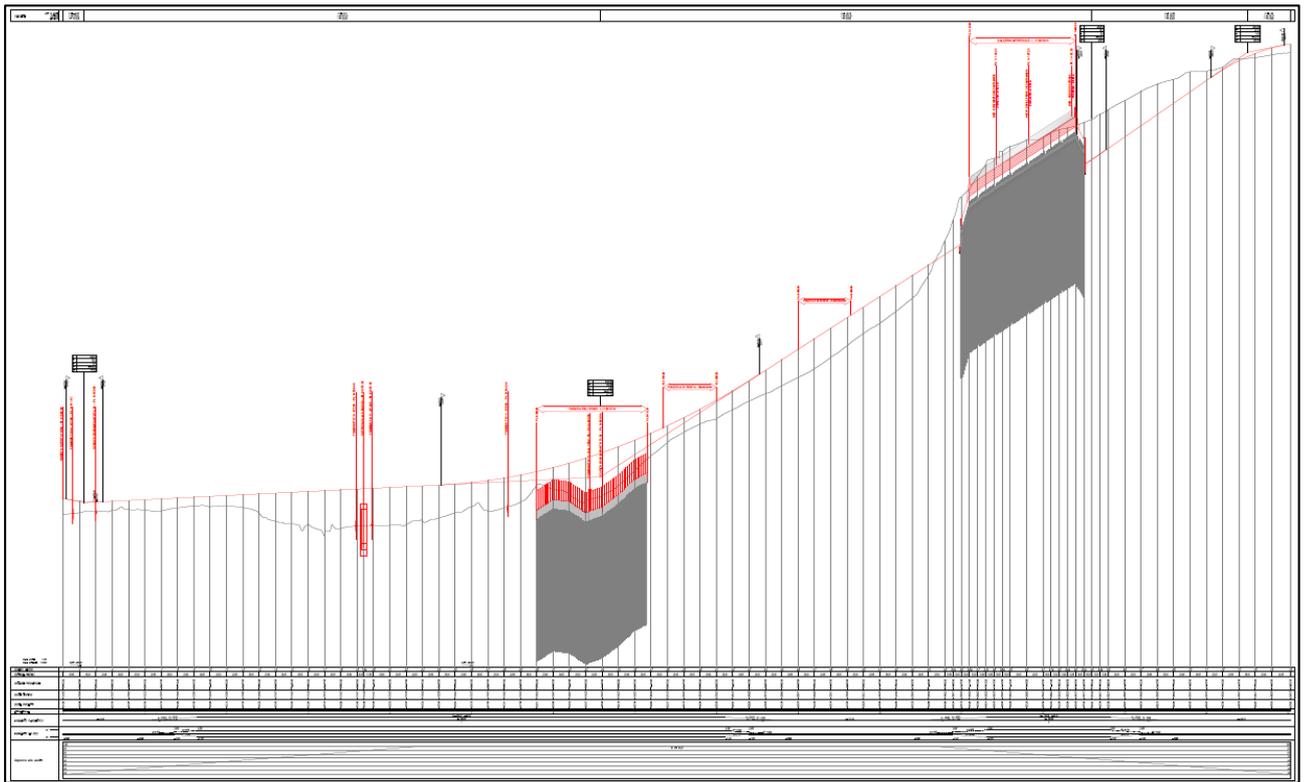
Profilo longitudinale del tratto di nuova realizzazione
